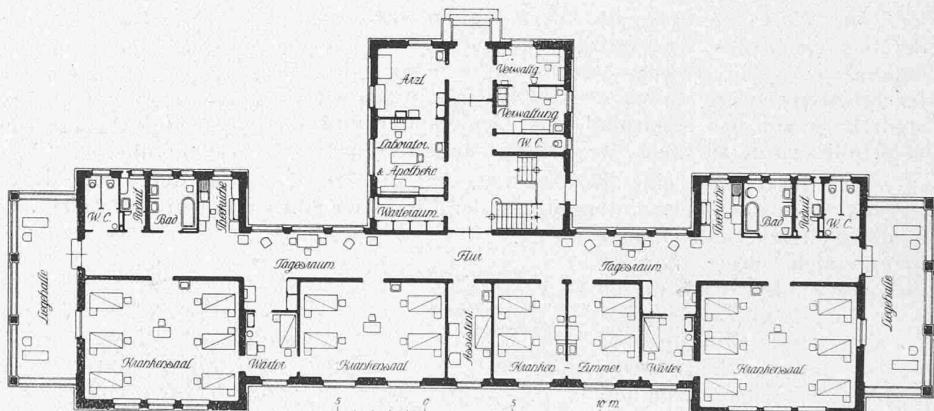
und 3. Grundrisse des Krankenpavillons B. — Masstab 1 : 400.
